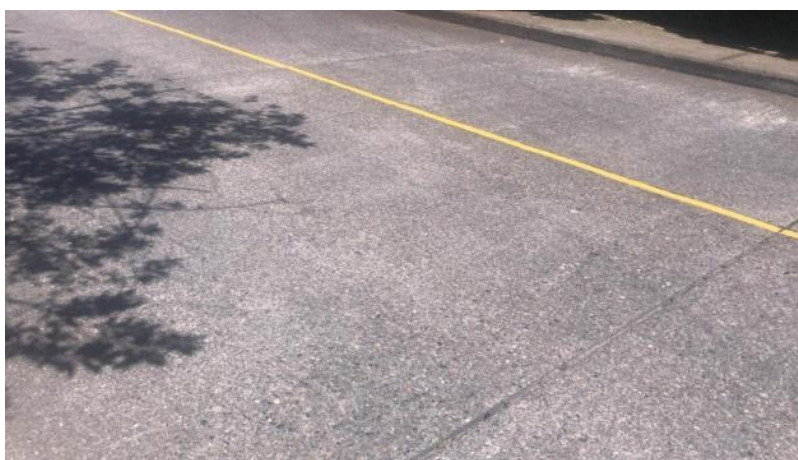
Grietas longitudinales en tramo vial Cr 15 con calles 16 y Av. 30 de Agosto
